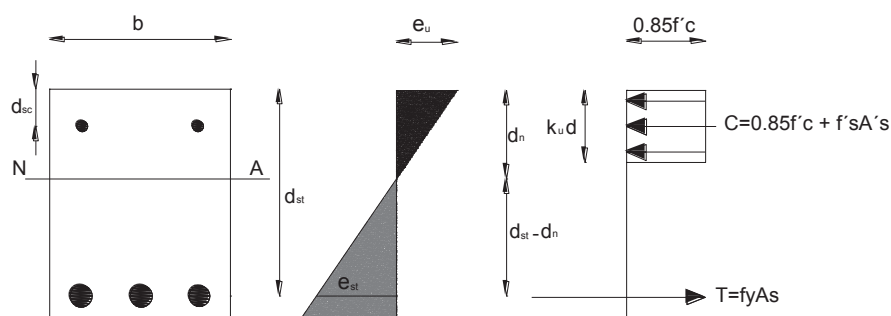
Sección rectangular con refuerzo de compresión y tensión
